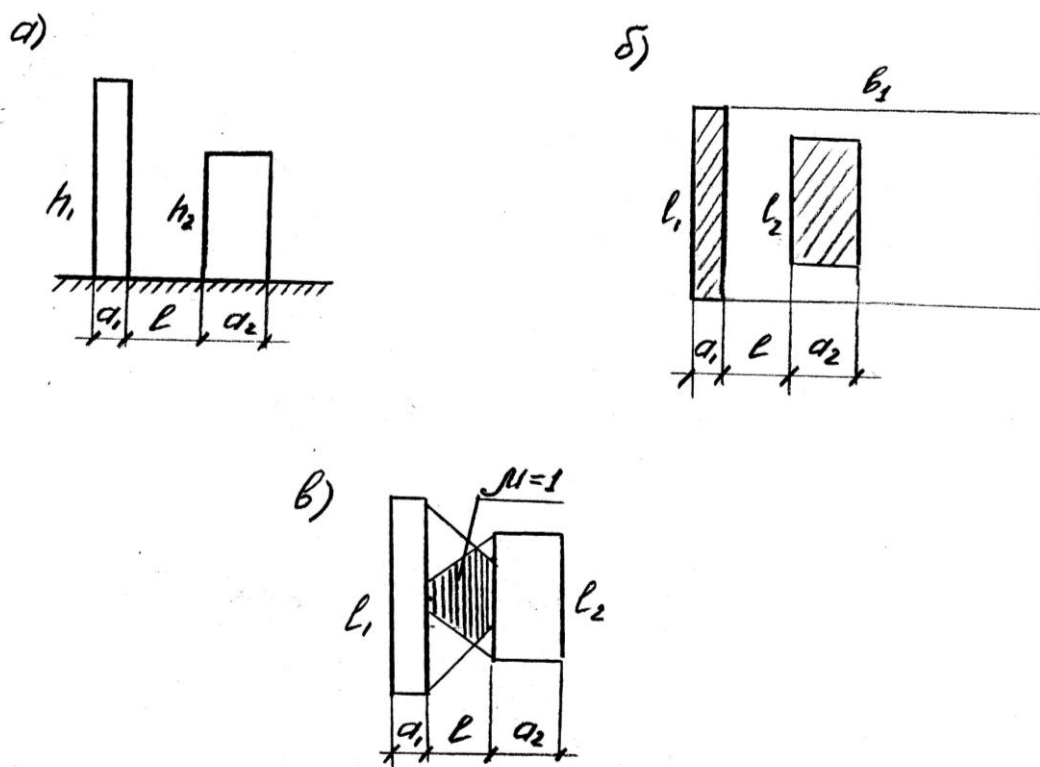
Иллюстрации к определению снеговой нагрузки на участке между вентиляцией и техническим блоком
